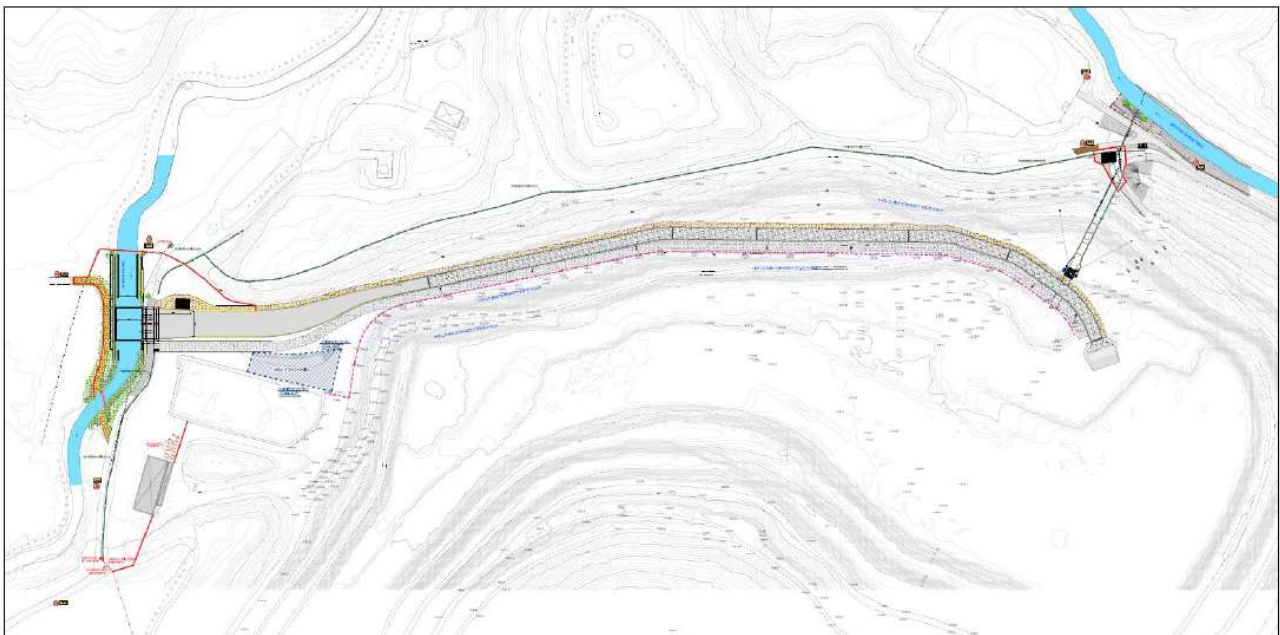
Planimetria di progetto dell'area di laminazione prevista nella Cava di Brenno.
